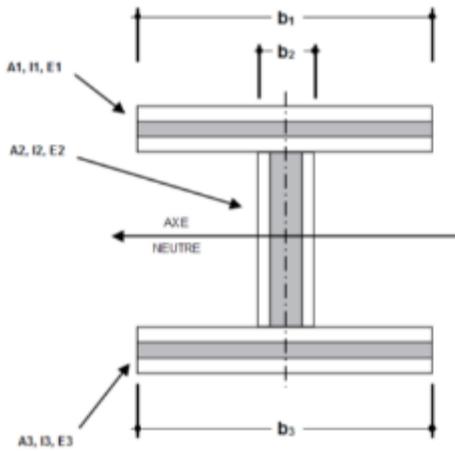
Section partielle d'un caisson NOVATOP ELEMENT
